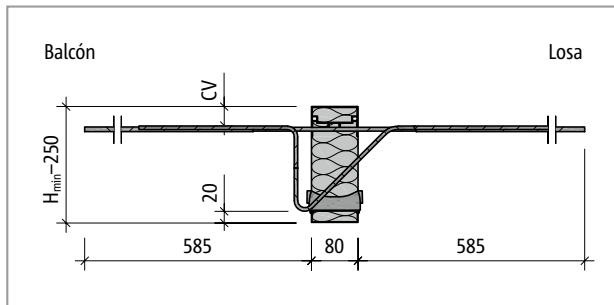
Schöck Isokorb® T tipo K-M1 hasta M4 en R0: Sección del producto
